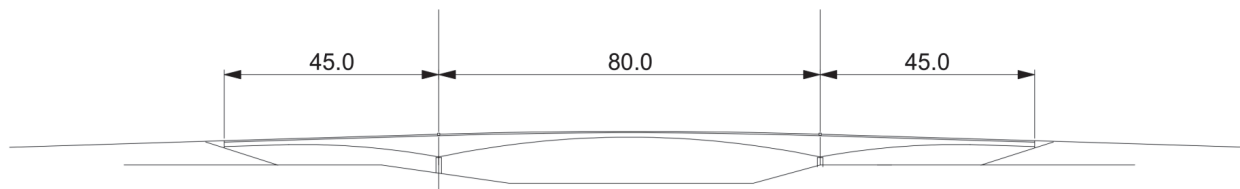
Soluzione progettuale di ponte a travata continua con sezione a cassone
